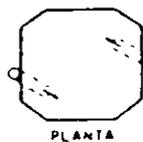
PILOTE HINCADO CON CHIFLÓN.
